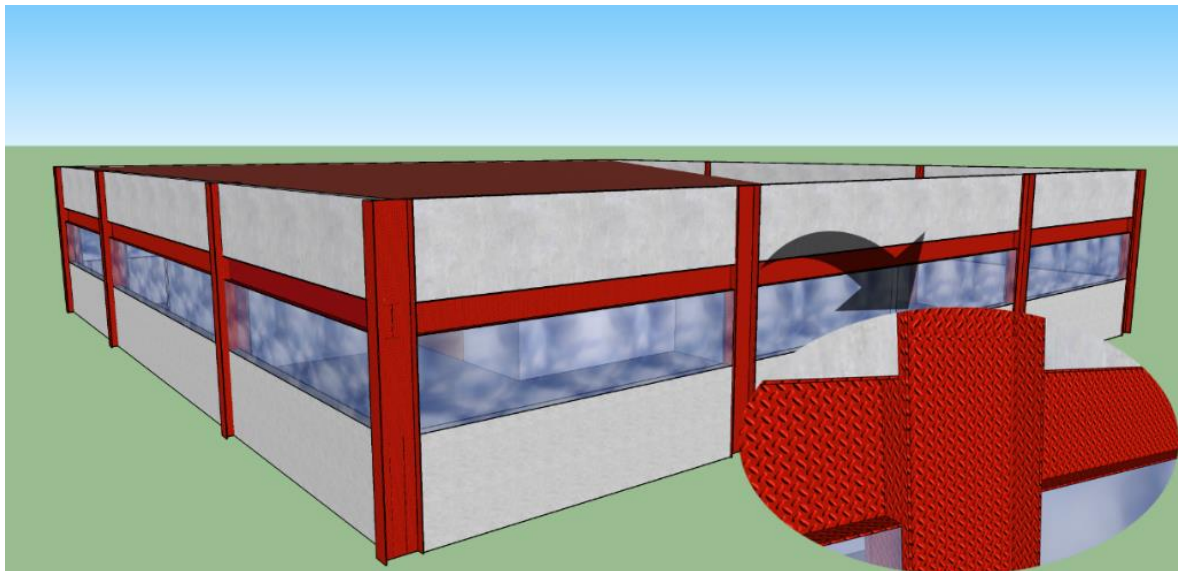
Perspectiva do último pavimento do edifício com estrutura adaptada em aço.
